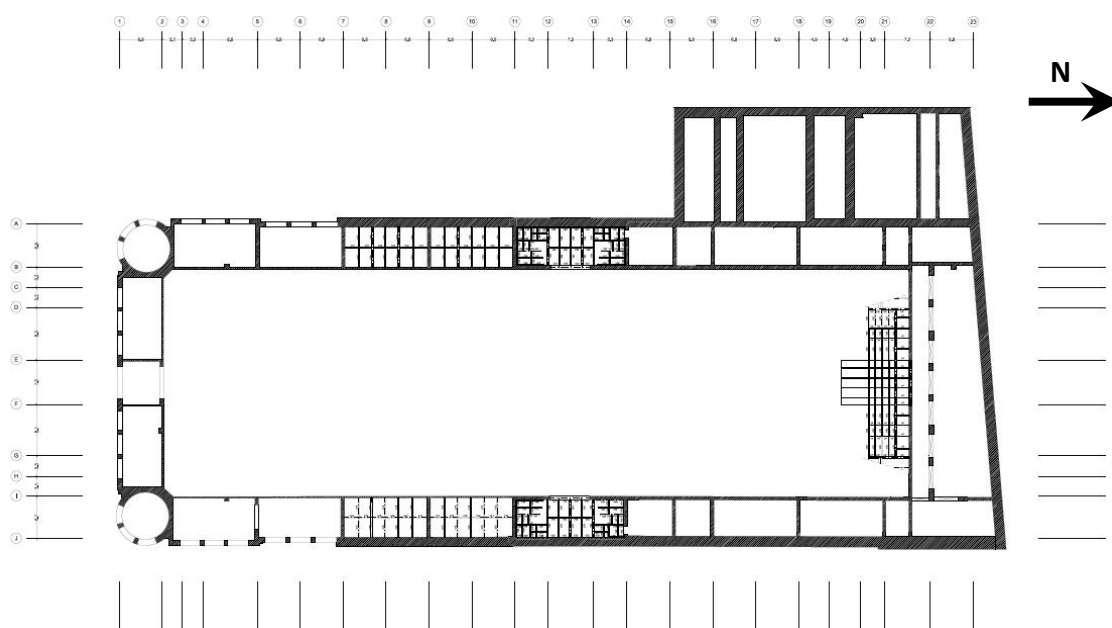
Planta estrutural do nível 0 do Mercado do Bolhão.
